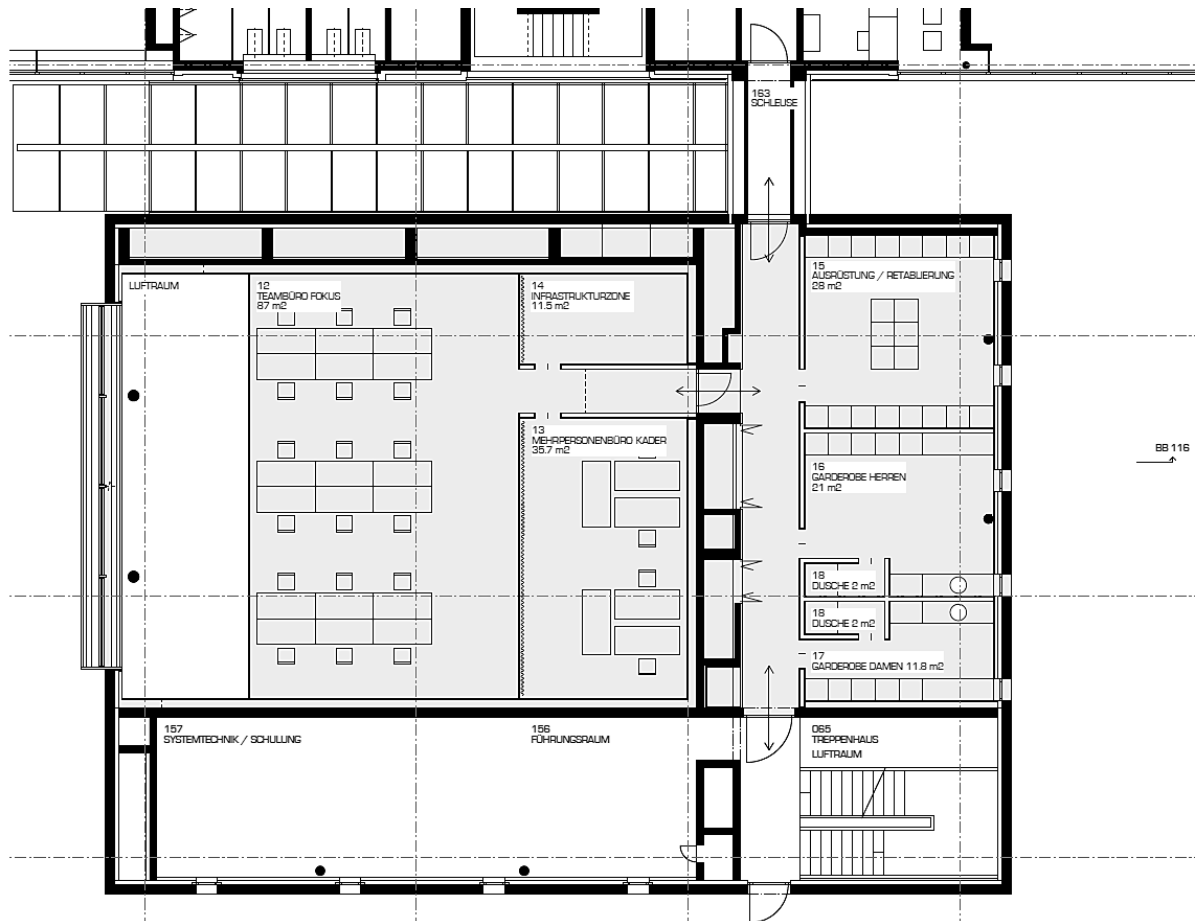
Grundriss 1. Obergeschoss ohne Masstab; Eingriffssperimeter graue Fläche
